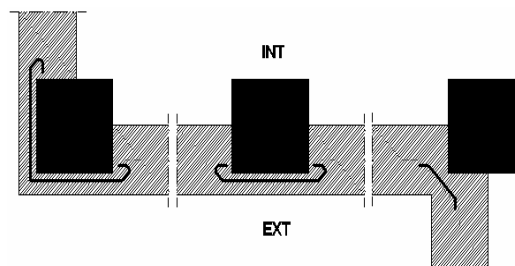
Ejemplo de encuentro de la fachada con los pilares
